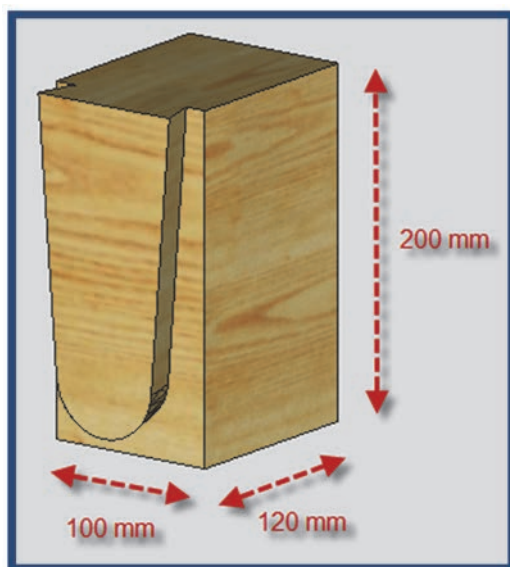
Probeta de madera laminada de castaño de sección de vigueta con espiga tallada en un extremo (diseño CAD)
